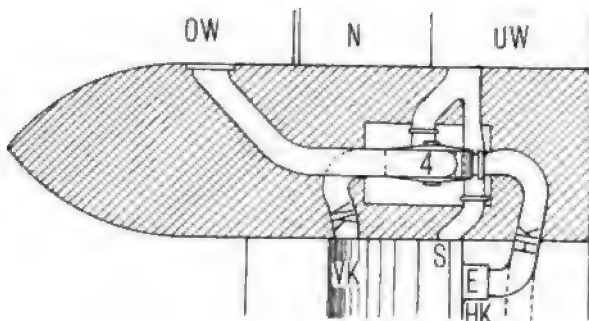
Horizontalschnitt durch die Verbindungs-
